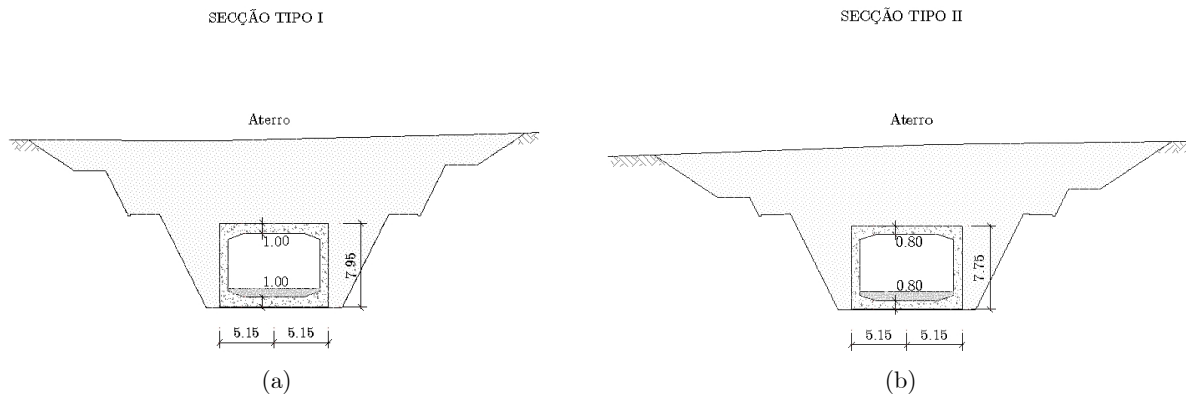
Cortes transversais: (a) corte transversal 4-4 correspondente à zona 1; (b) corte transversal 5-5 correspondente à zona 2.
